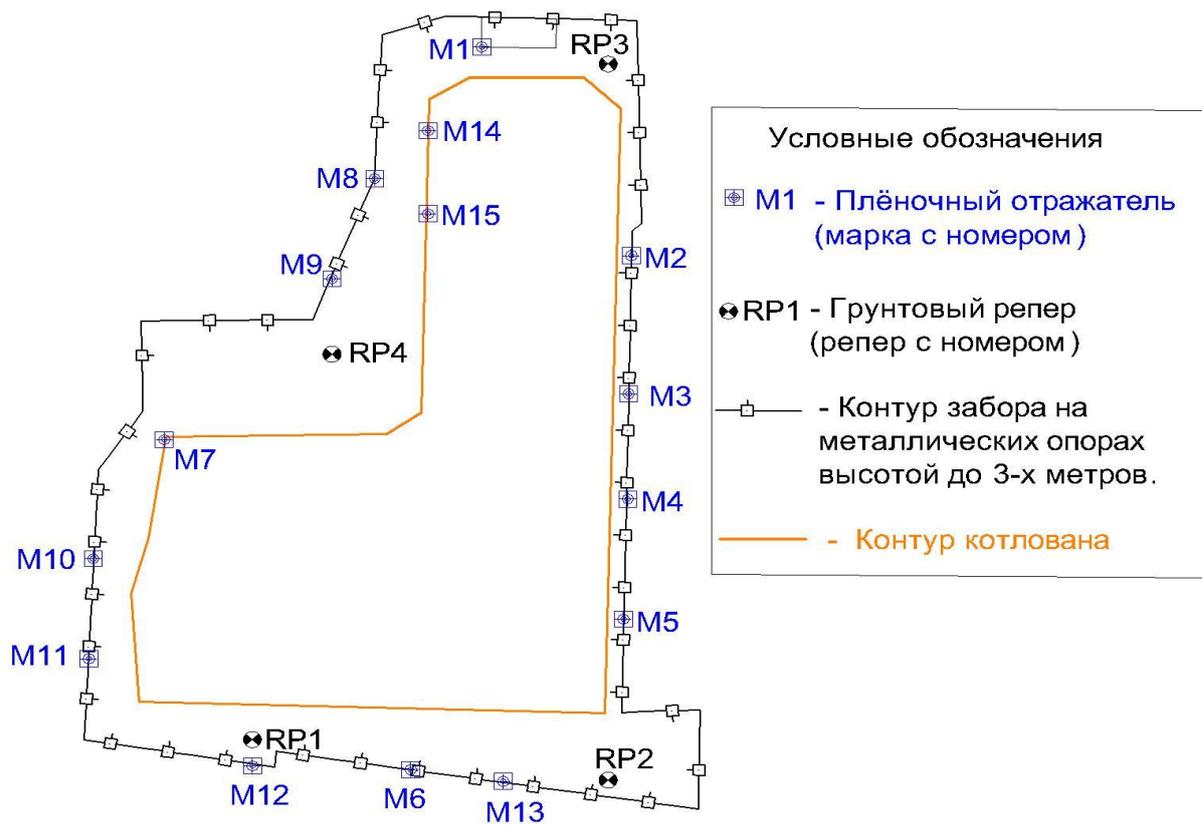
Схема строительной площадки с расположением реперов и ПО
